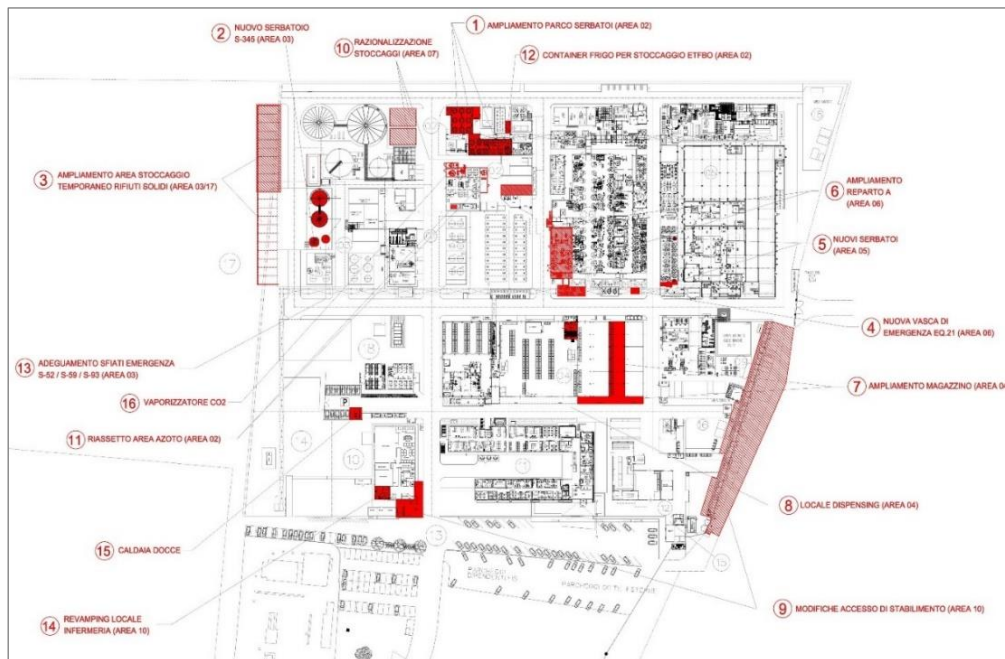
Estratto planimetria generale dello stabilimento FIS con individuazione delle aree previste per le opere in progetto
